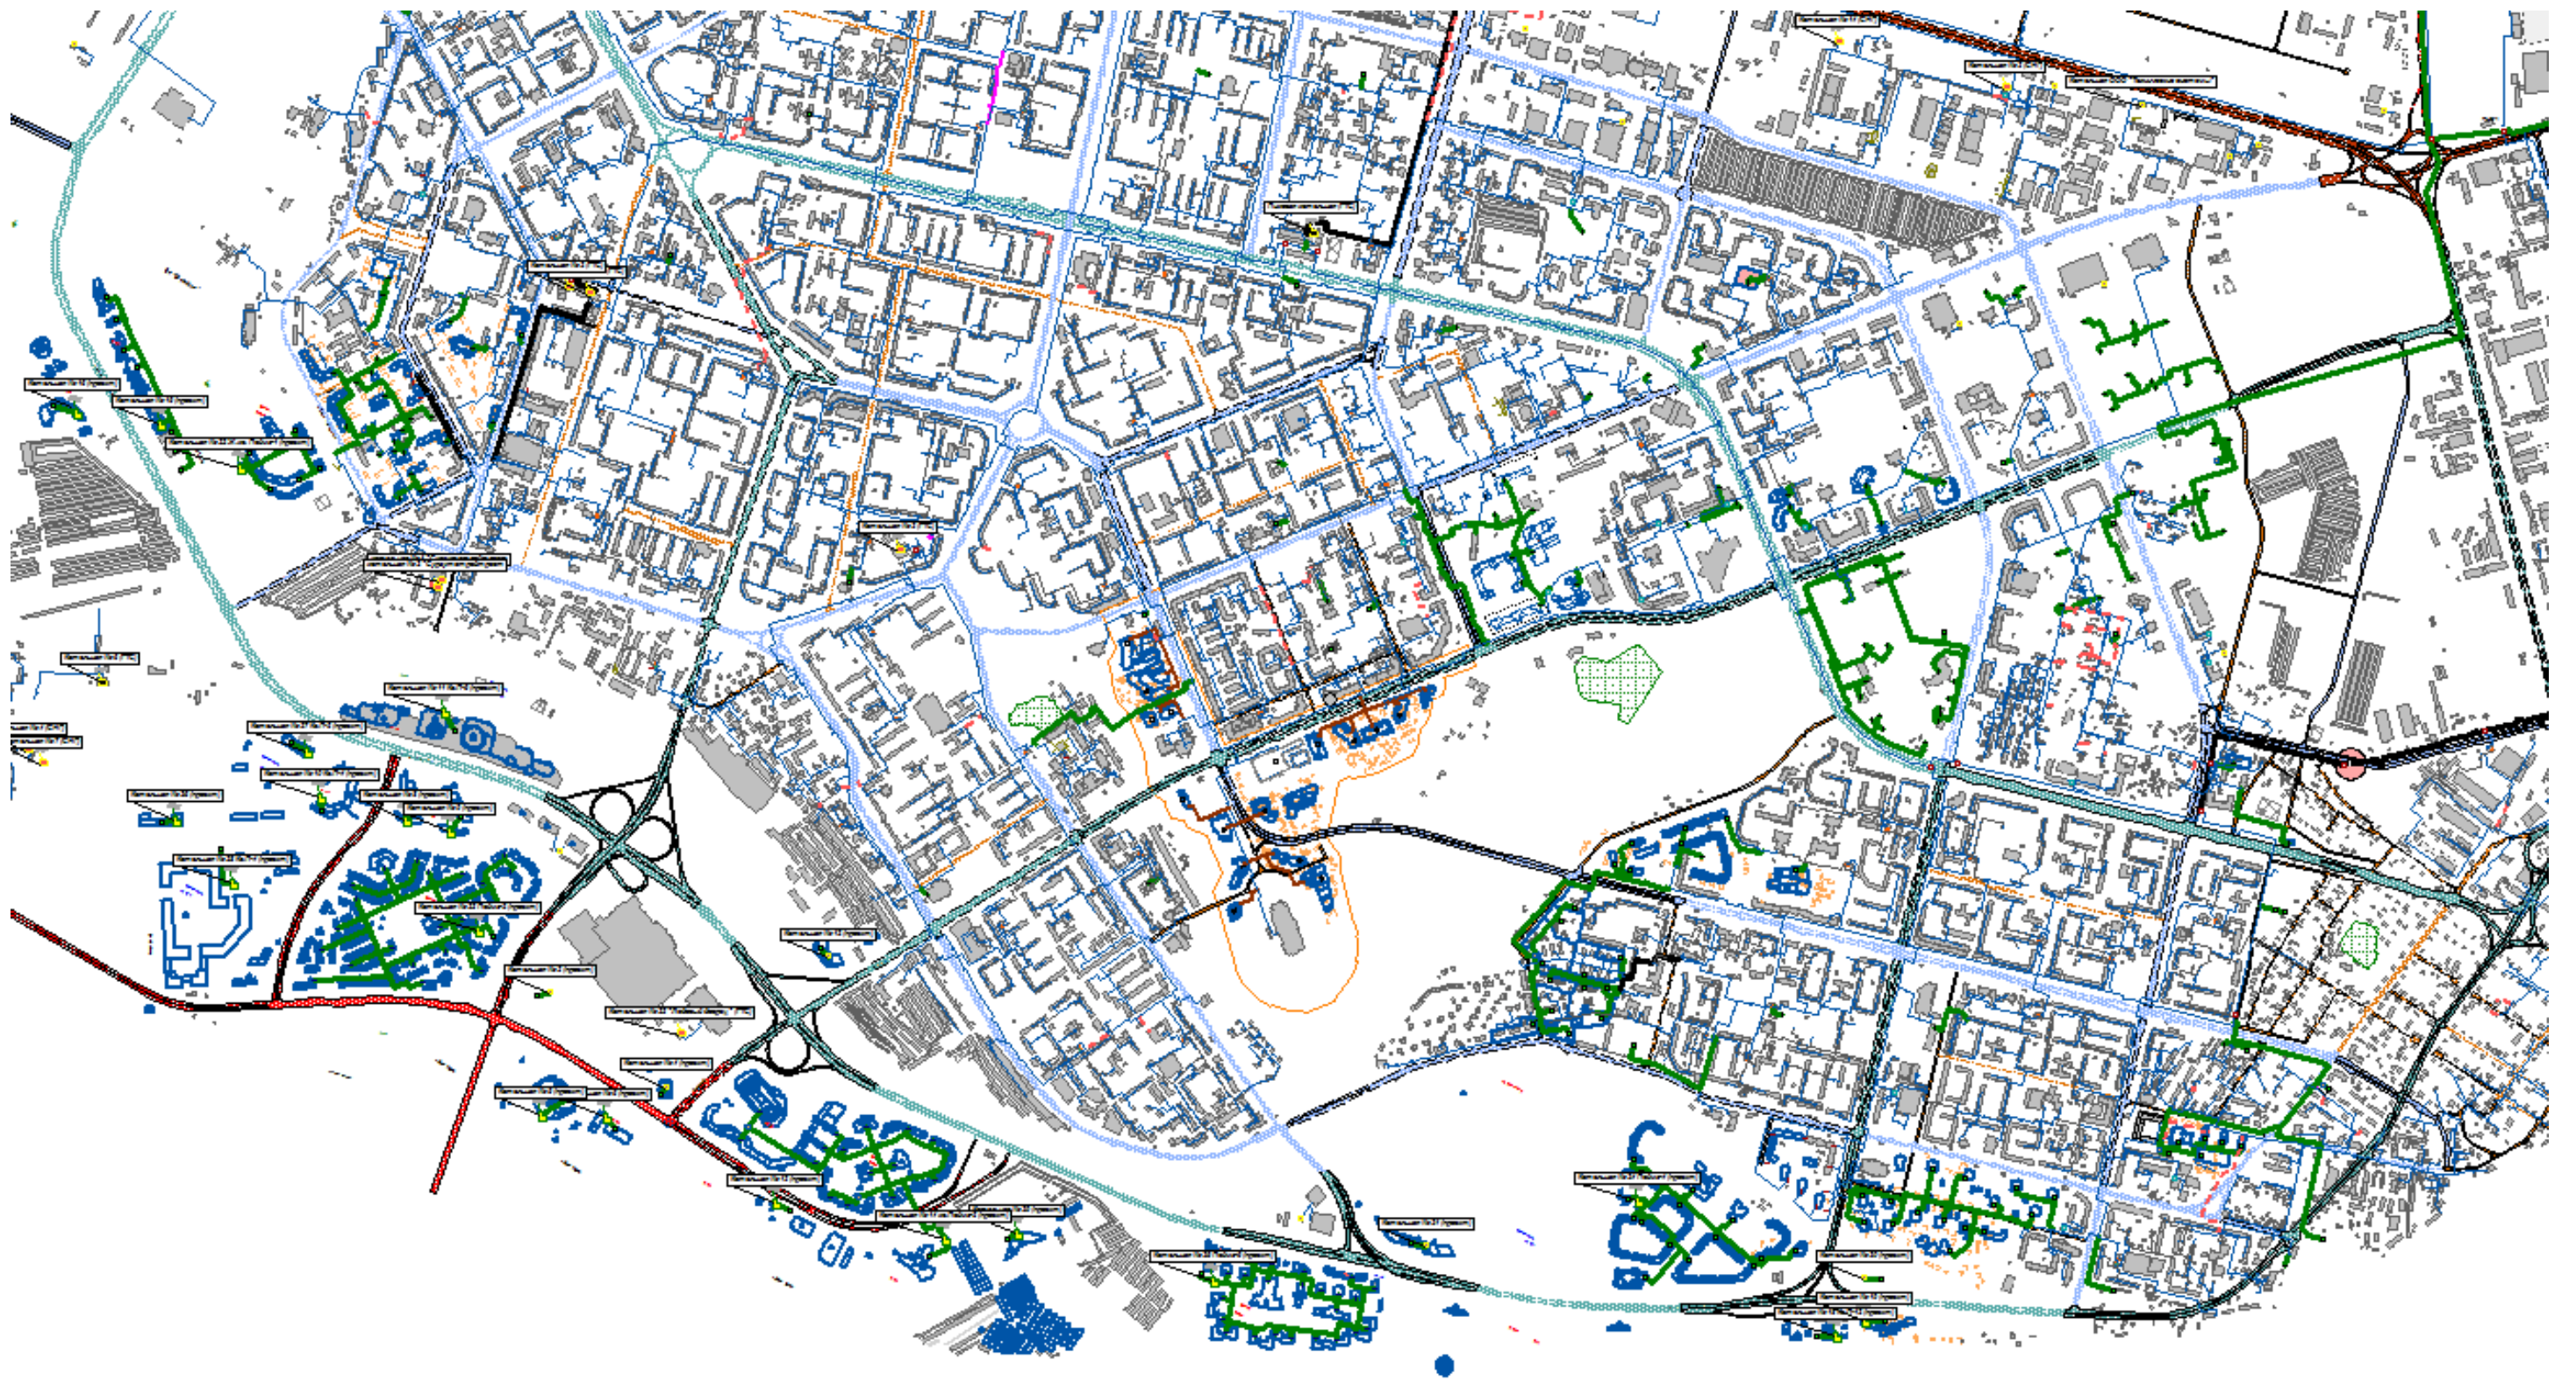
План-схема развития систем теплоснабжения по варианту №2
